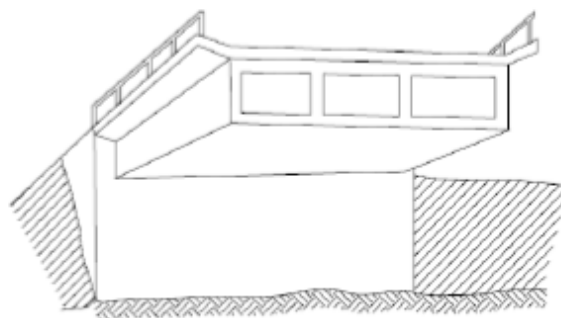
Puente vigas cajón postensado (Fuente: Aranis)
